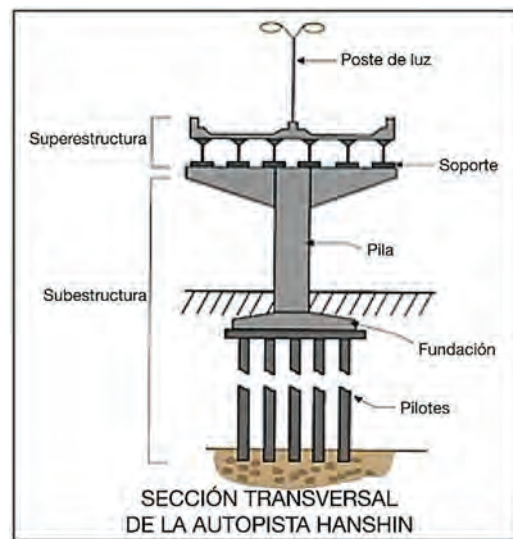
Sección transversal del sistema estructural de la Autopista de Hanshin. (Fuente: EQE, 1995, p. 47)
